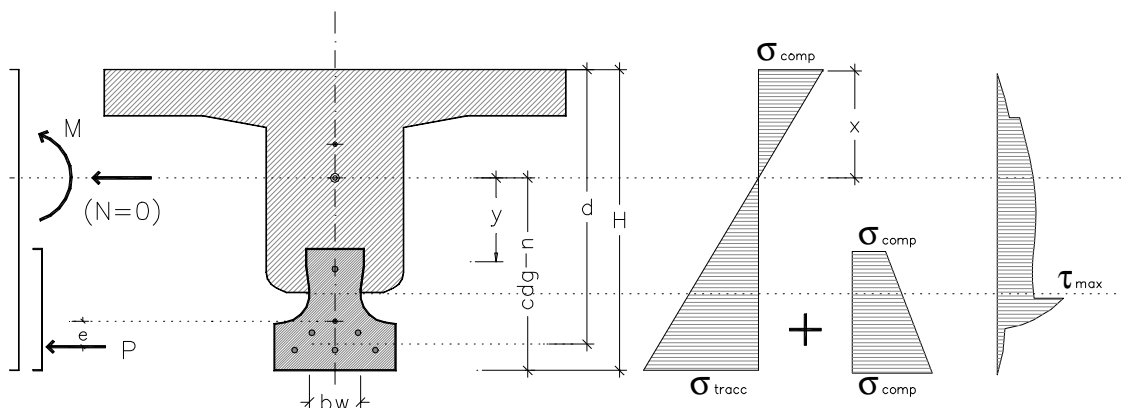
Tensiones en una sección general de un nervio de forjado de vigueta pretensada. Hormigón sin fisurar en servicio
